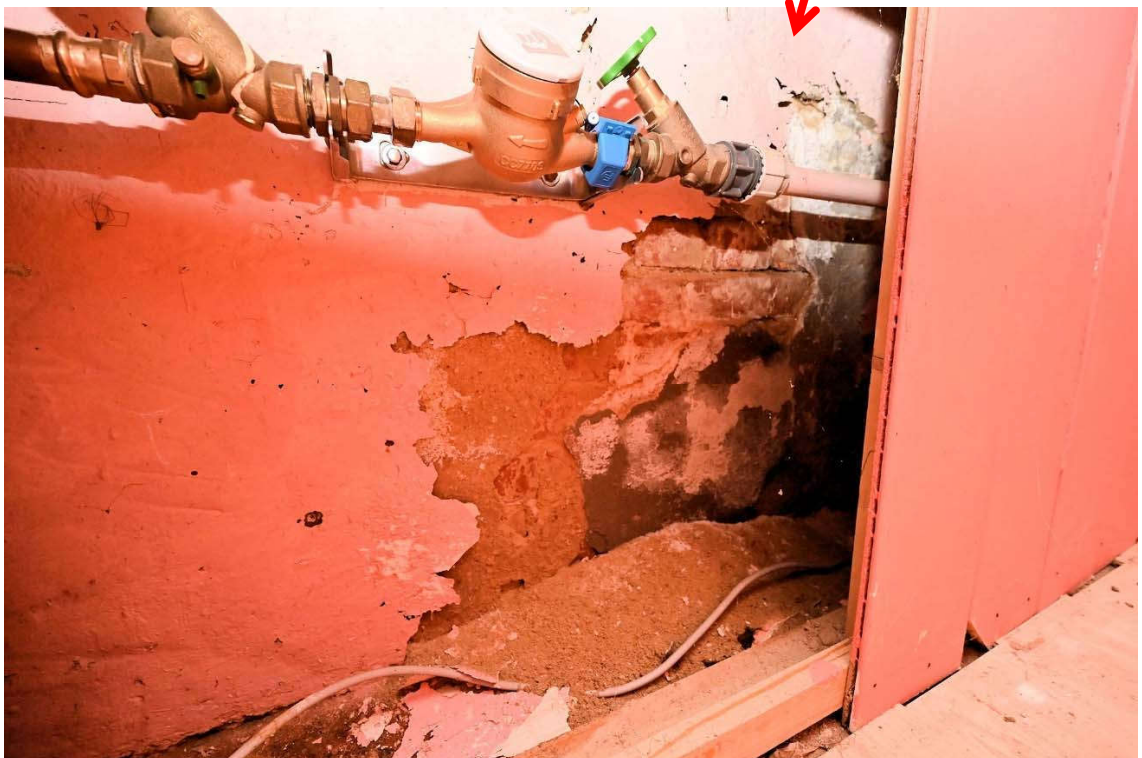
Gebäude A, Teilkeller, Detail Absandungen
